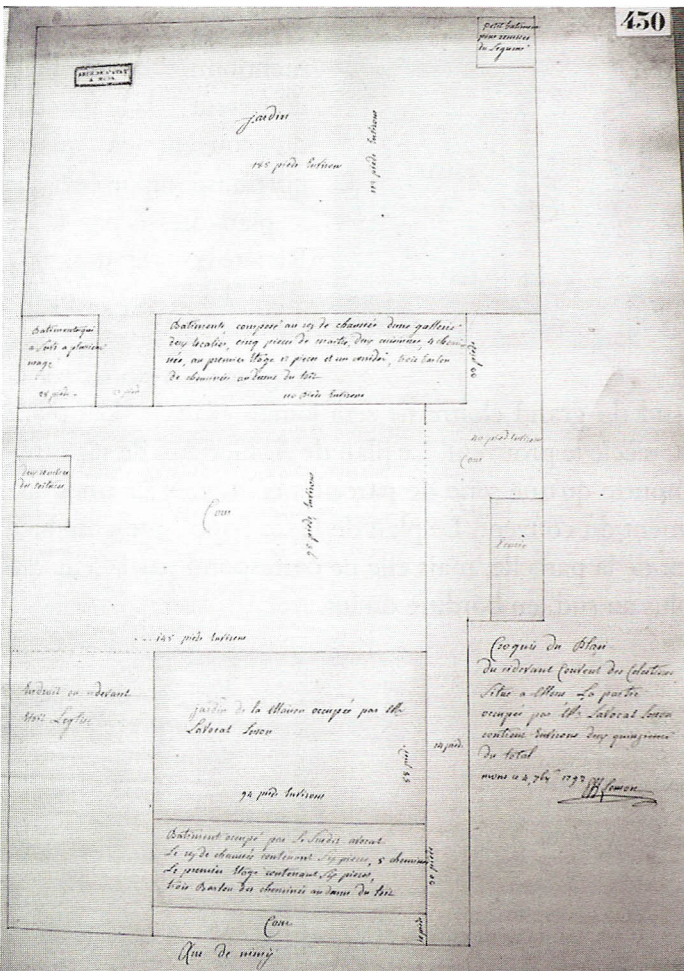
Mons, couvent des Célestines, plan simplifié d'une partie du couvent, 1792, cliché de l'auteur. (A.É.M., fonds Cartes et Plans, n° 430).
